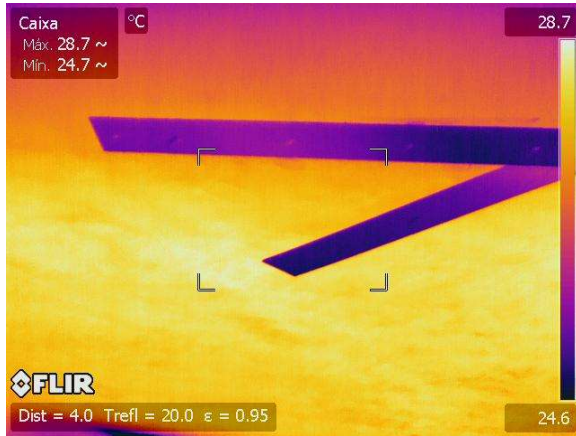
b – E.AP.R Cortina de Concreto do Viaduto
